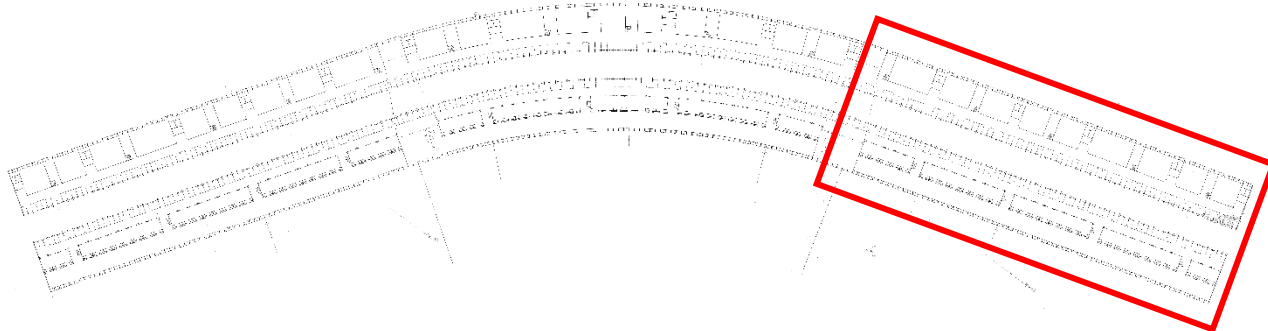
Planta baixa do ICC, com destaque em vermelho da localização do ICC Norte.
